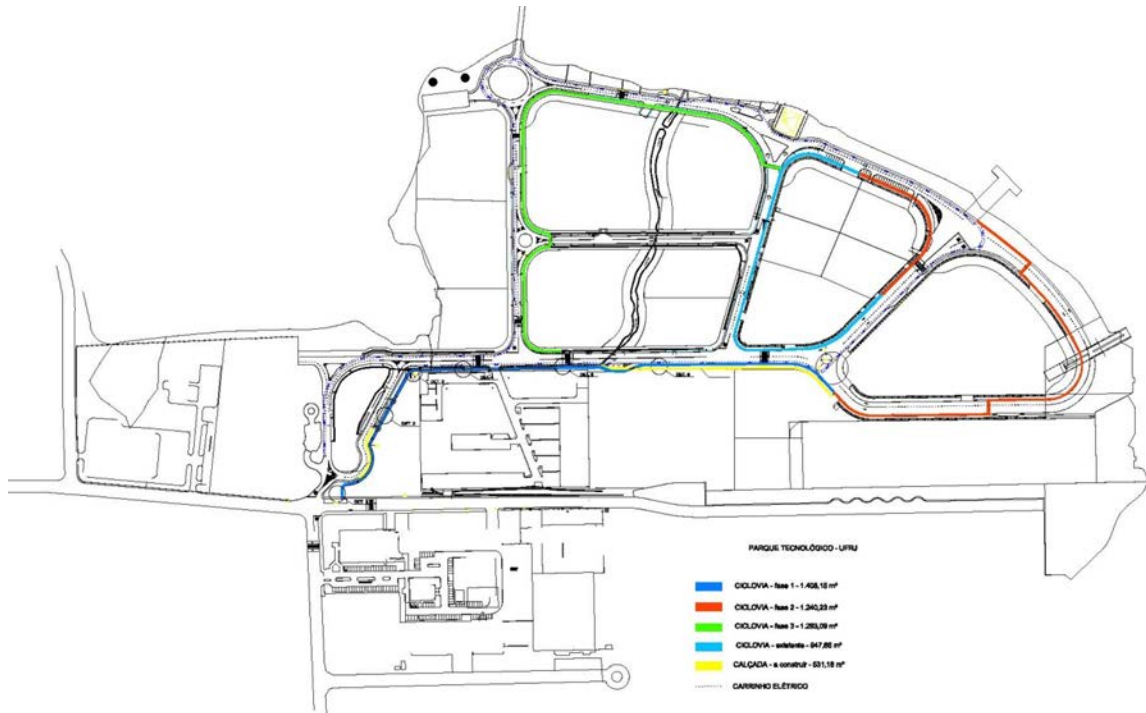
Planta de situação e localização das ciclovias no Parque Tecnológico.
